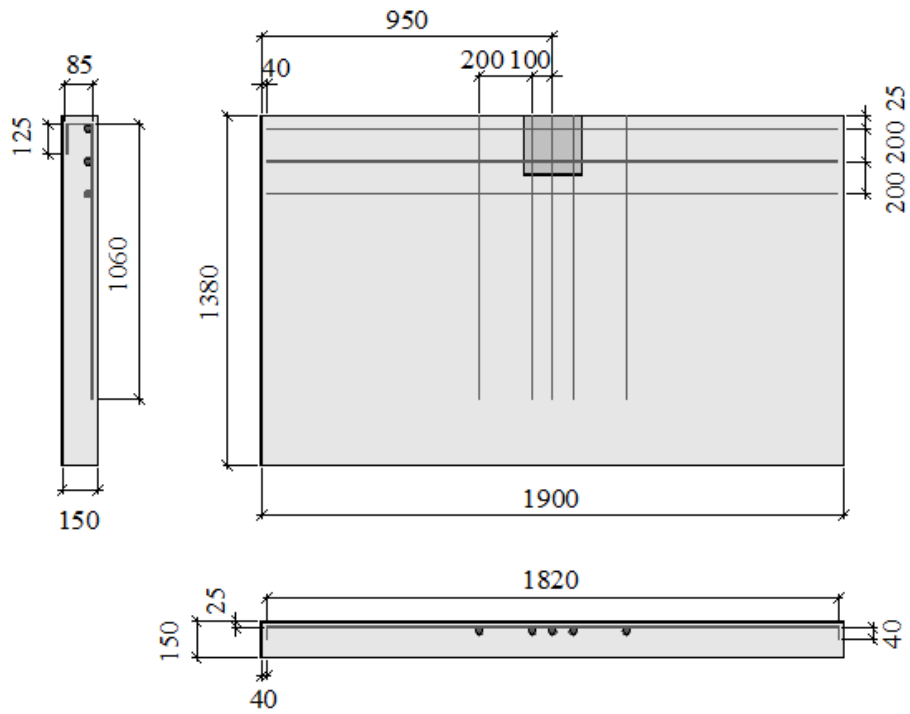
Disposição da armadura tracionada para lajes sem *overhang* – Dilger (1989)
